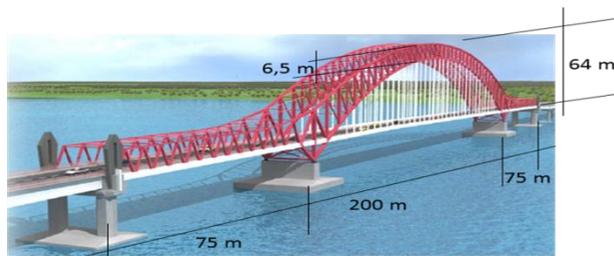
Rencana Pemasangan Segmen Tengah Steel Girder
